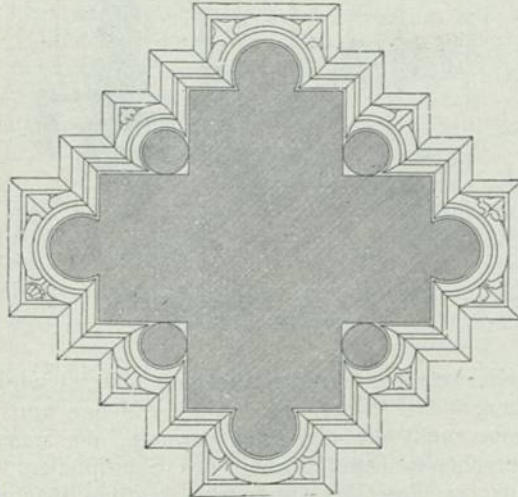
Grundriss eines gegliederten Pfeilers
